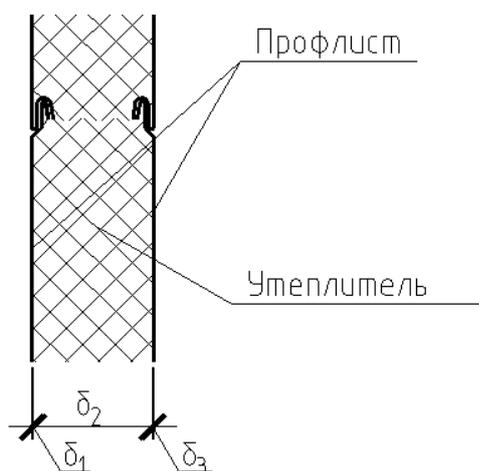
Расчетная схема стеновой ограждающей конструкции
